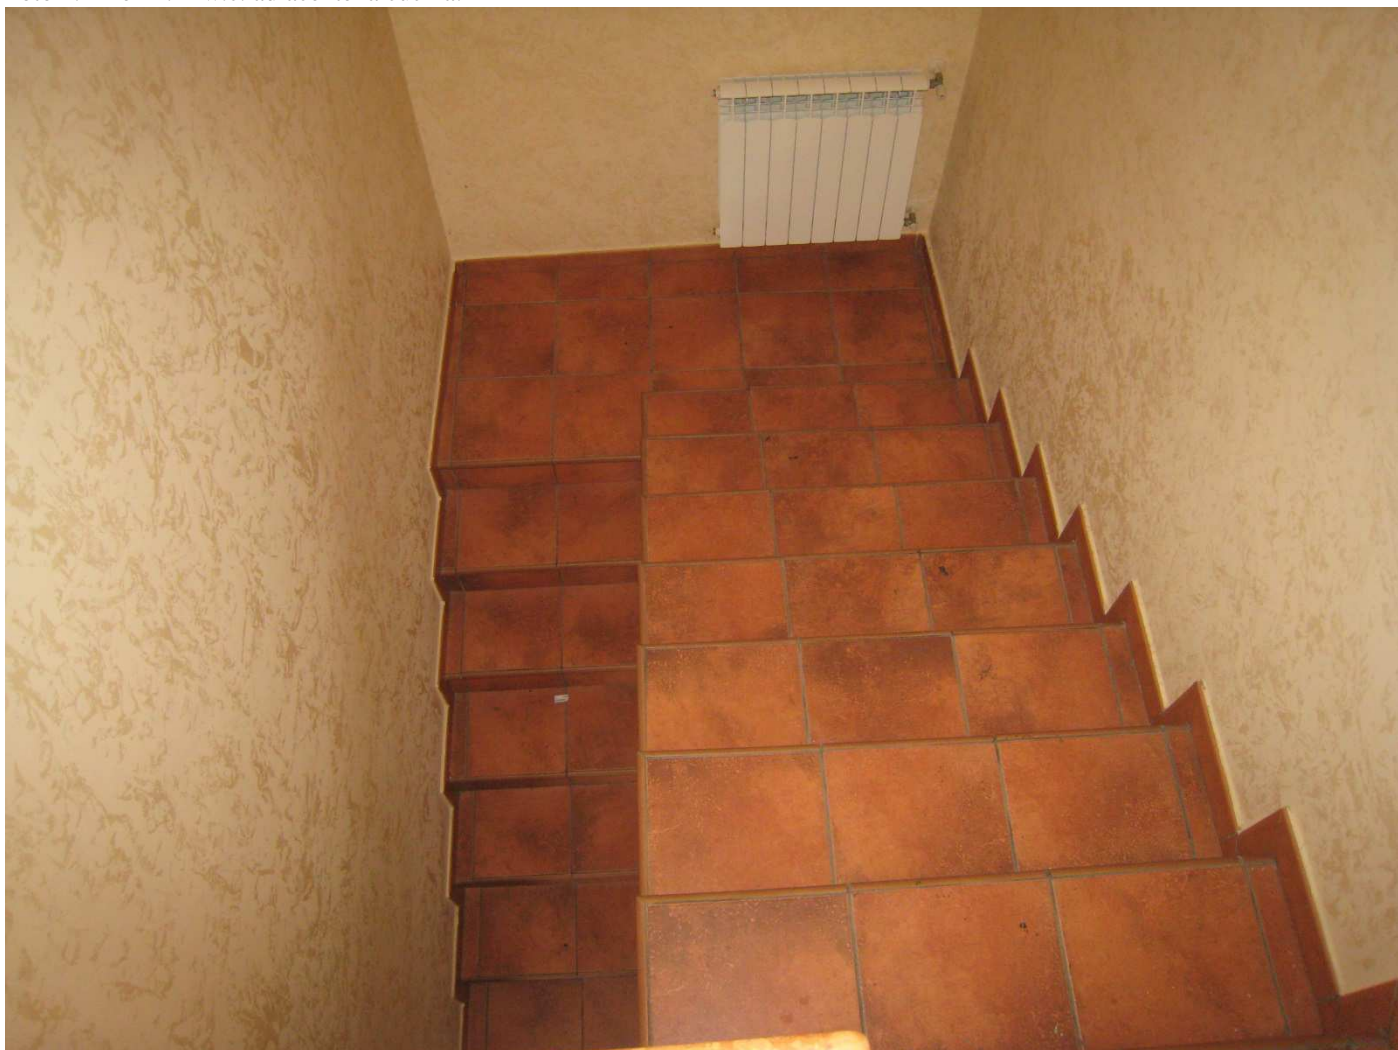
Le scale che collegano il 1° al 2° piano mancano del passamano o parapetto.
